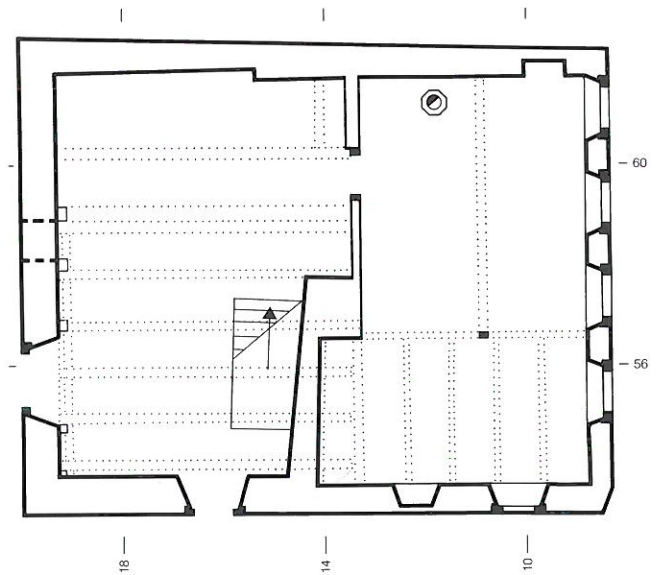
Unterseen - Obere Gasse 42. Grundriss des 1. Obergeschosses. M. 1:150.
